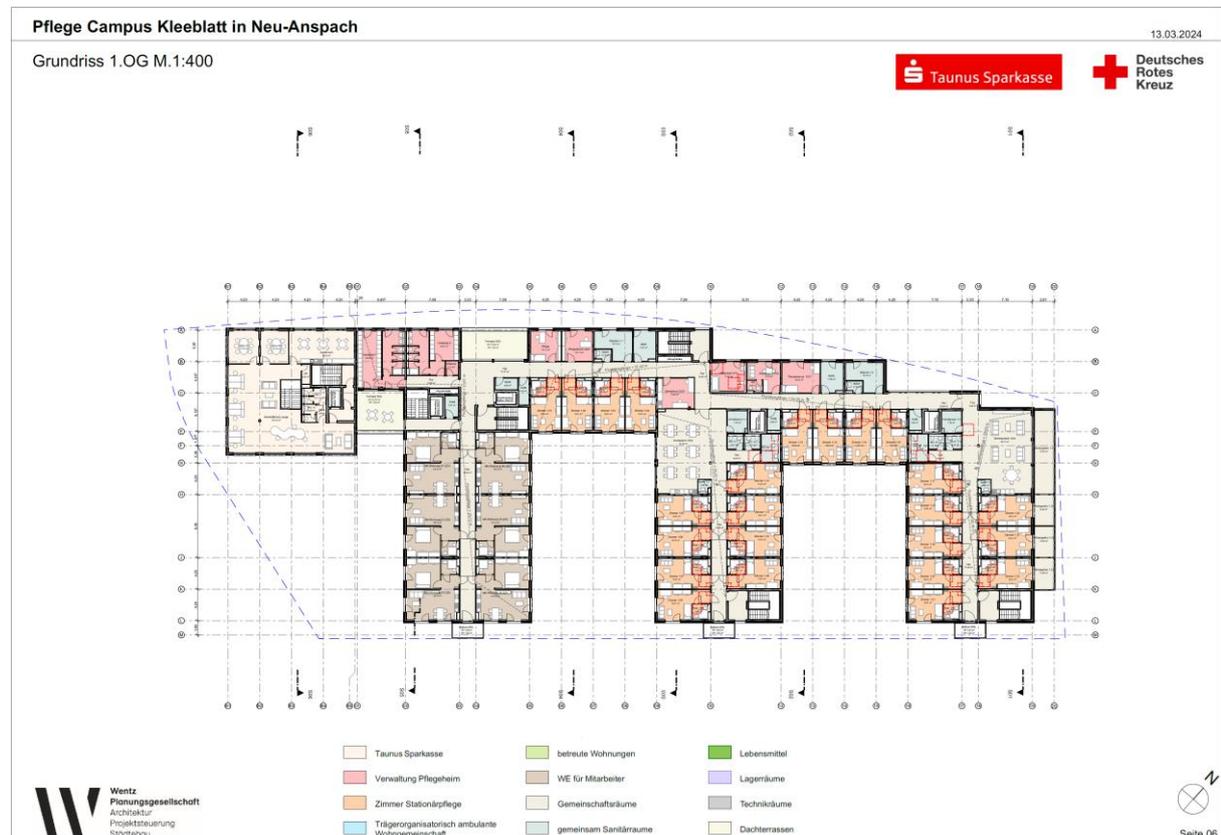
Grundriss 1. OG, unmaßstäblich
